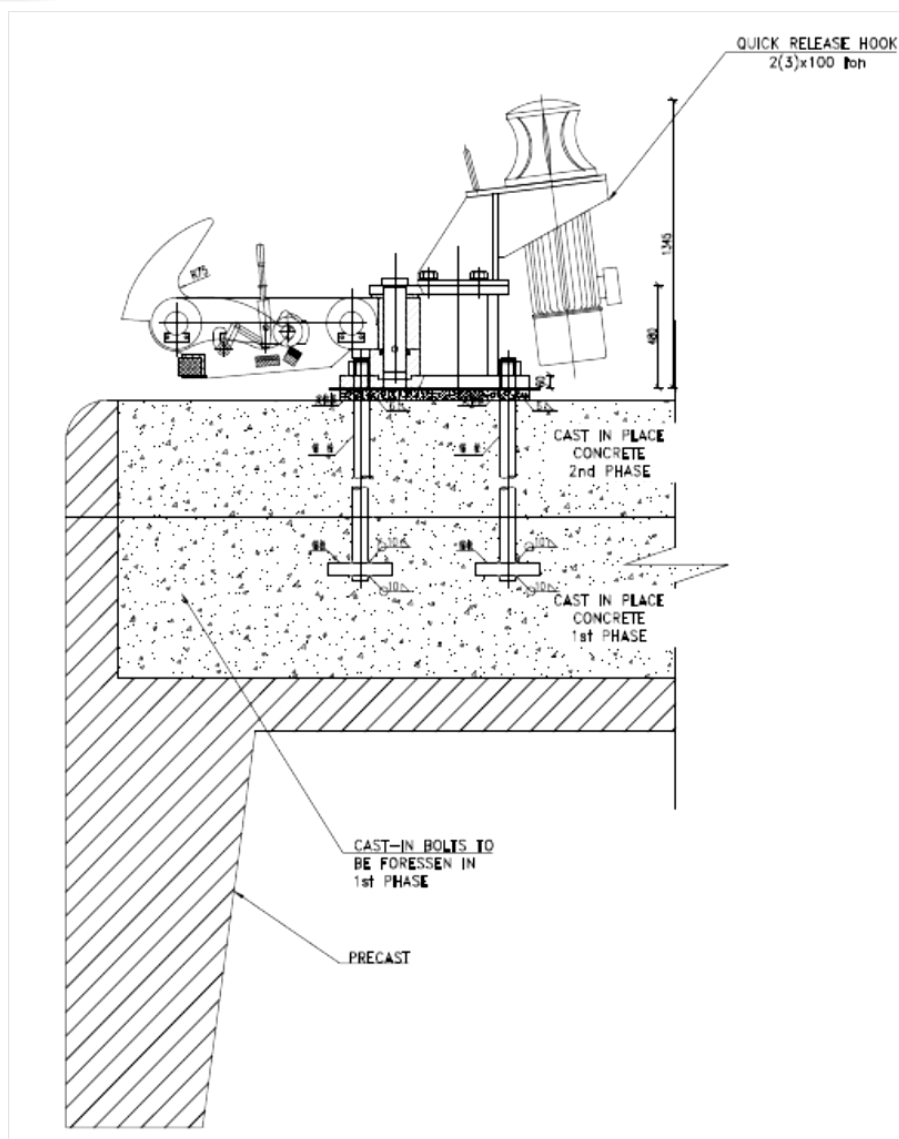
Ilustração de um cabeço de amarração. Fonte: LC Terminais (2025).
